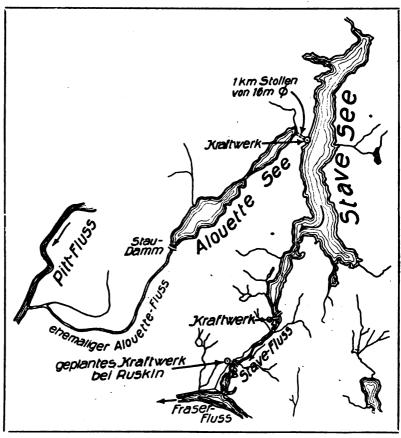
Befamtlageplan ber verbundenen Bafferkraftanlagen
